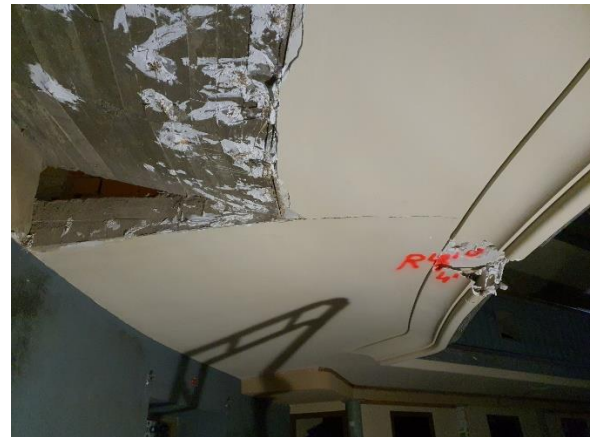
Vista general y detalle de la cata realizada en el zuncho de borde de la platea alta, para comprobar la existencia del armado inferior. Se observa la elevada oxidación de la armadura.
